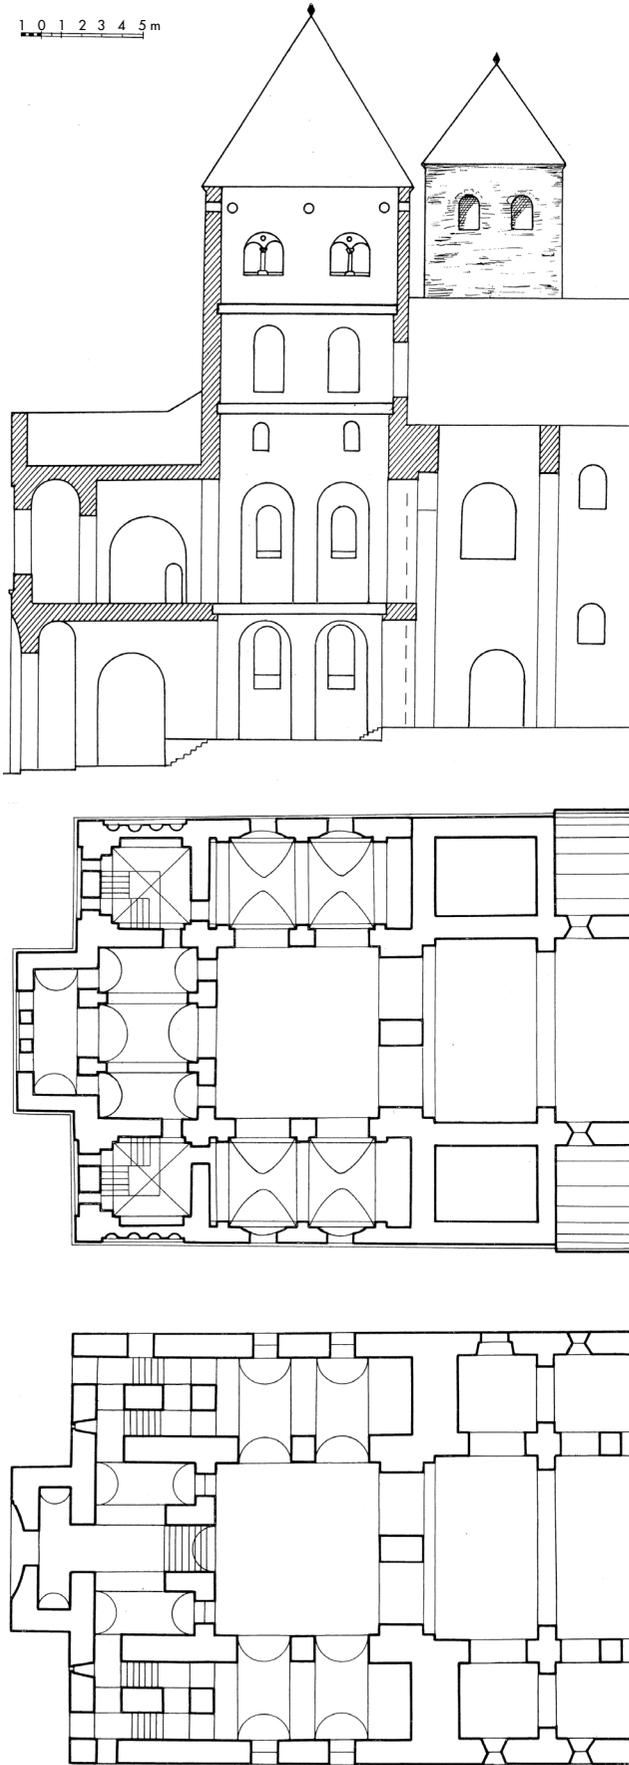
Werden, St. Ludgerus. Westbau, Längsschnitt nach Norden, Grundriss des Obergeschosses und des Erdgeschosses.
